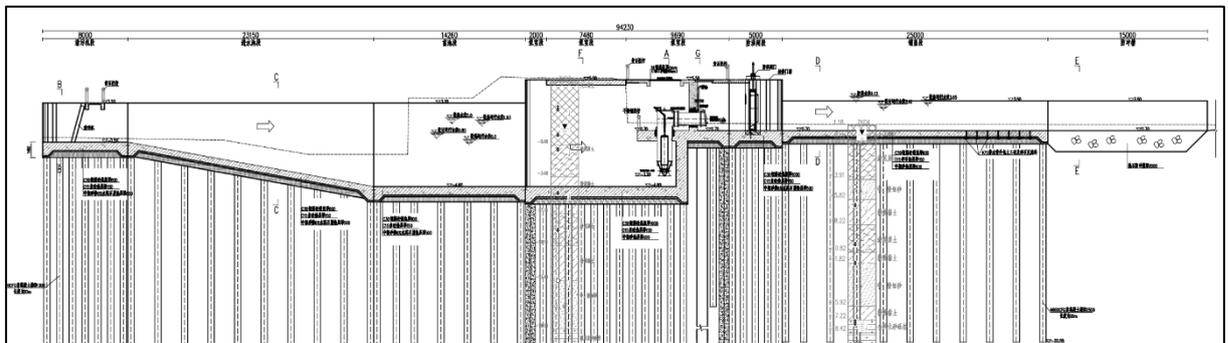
十字海泵站 2-2 纵剖面图（推荐方案）
